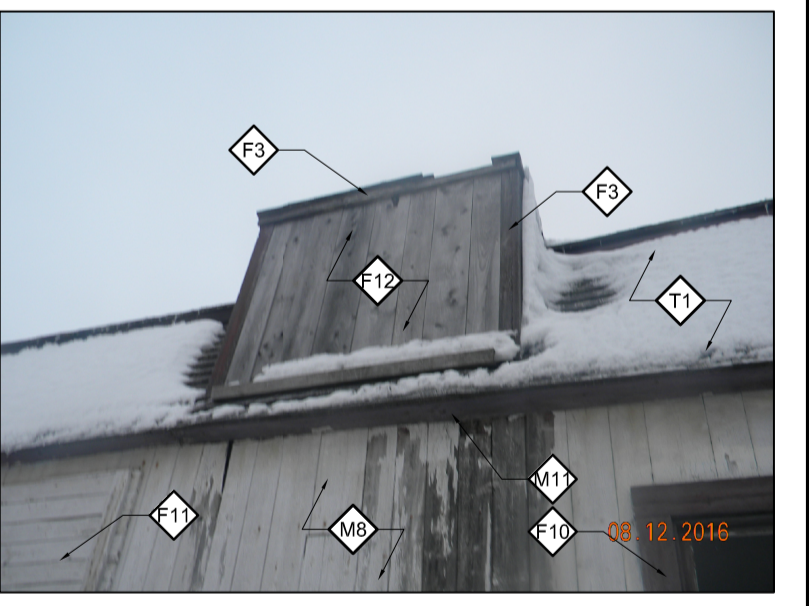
LUCARNE RECOUVERTE DE PLANCHES VERTICALES À DÉMOLIR.
